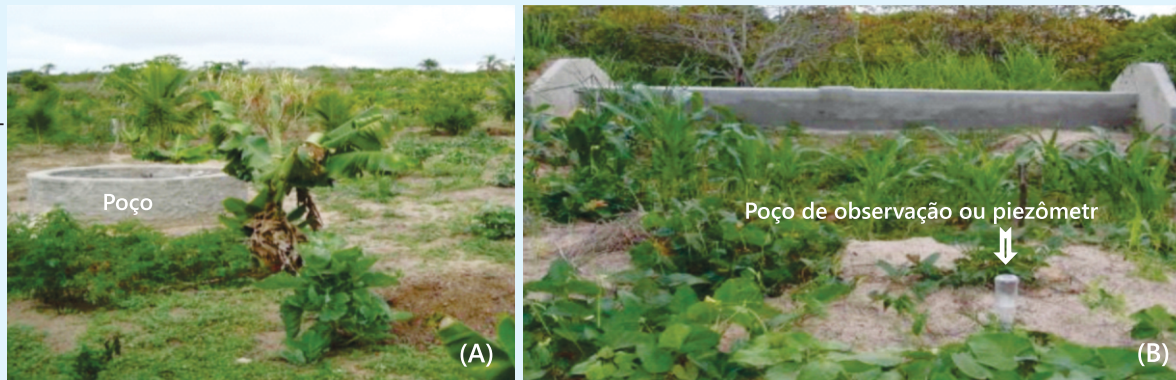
Poço instalado dentro da área de plantio da barragem subterrânea (A); piezômetro instalado dentro da área de plantio da barragem subterrânea (B).
